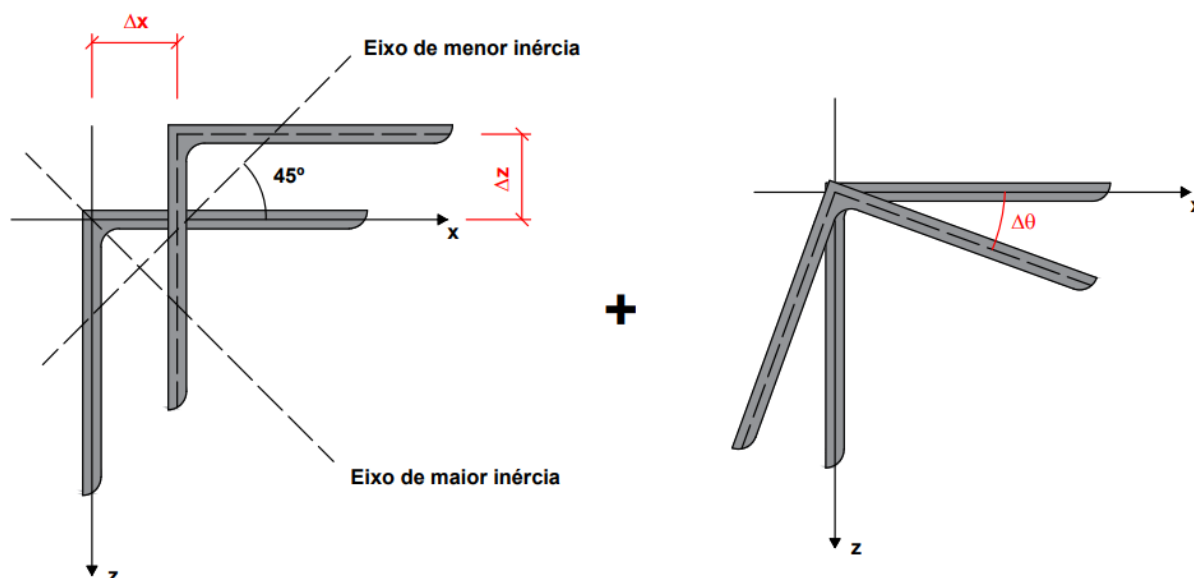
Representação das imperfeições adotadas para a flambagem por flexo-torção.
